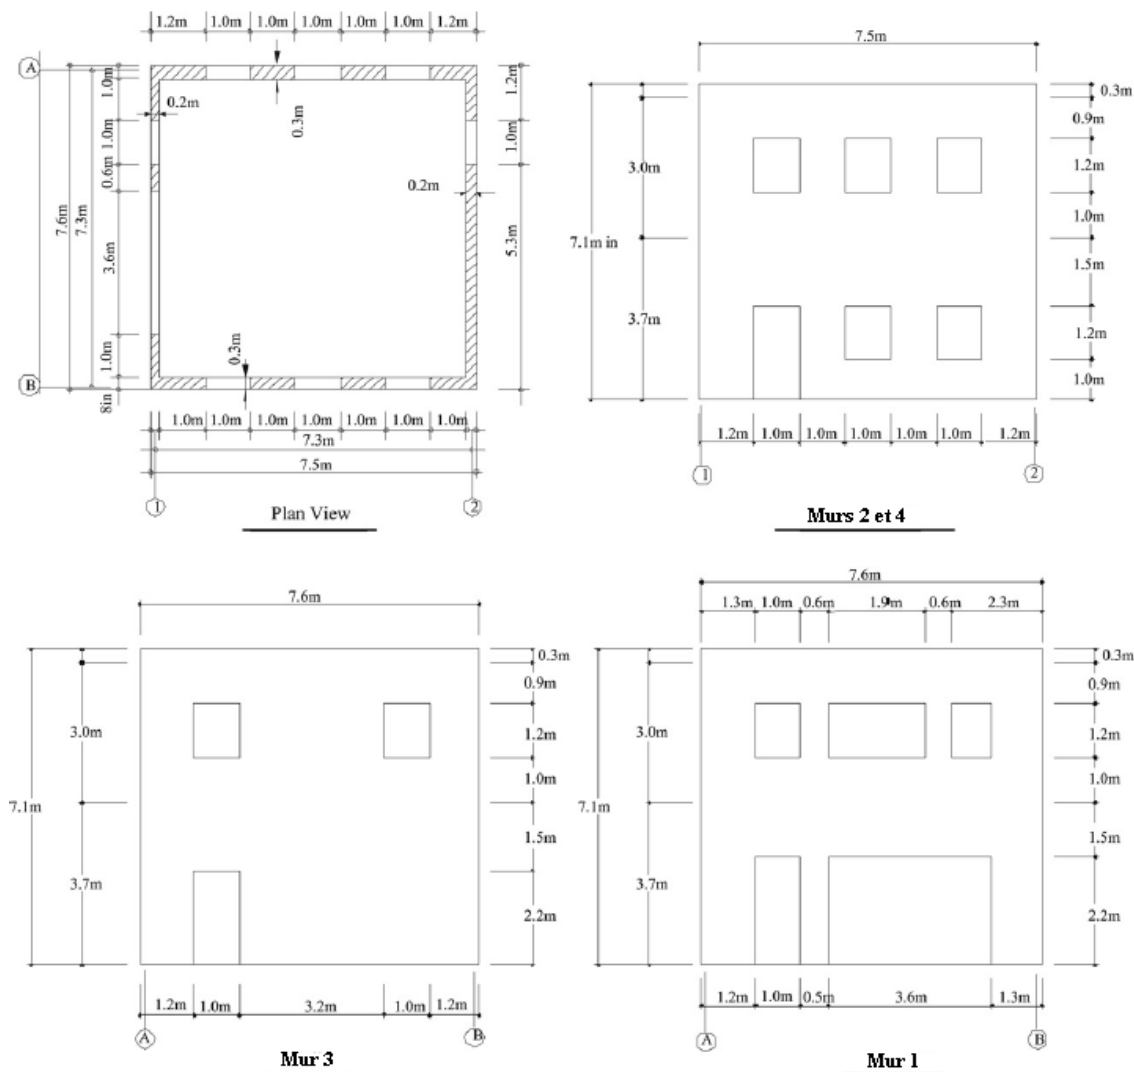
Plans et dimensions du bâtiment-type II (Park et al., 2009)
